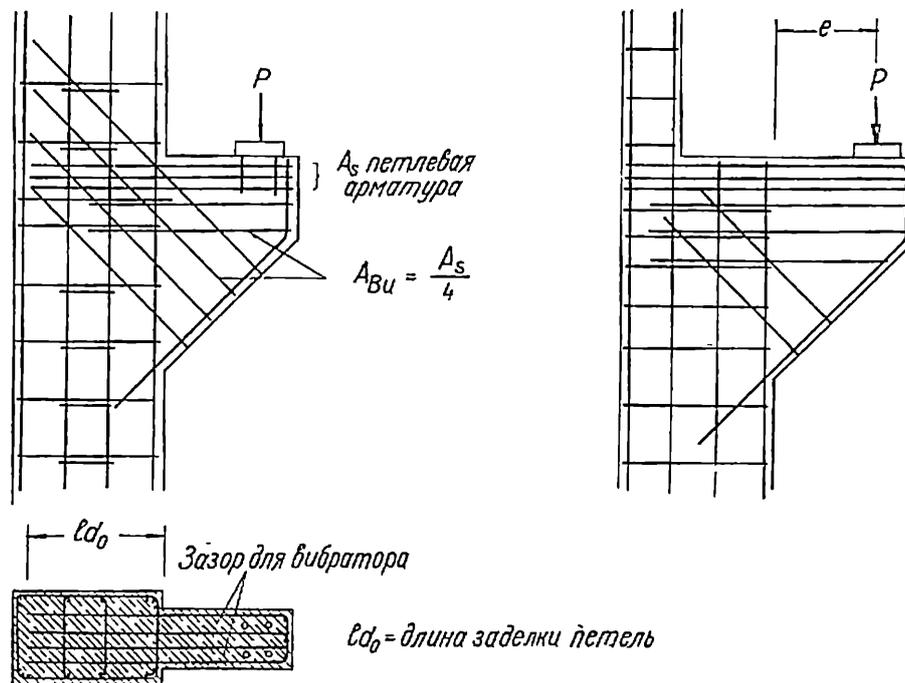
3. Армирование сильно нагруженной консоли (колонны для подкрановых путей)
